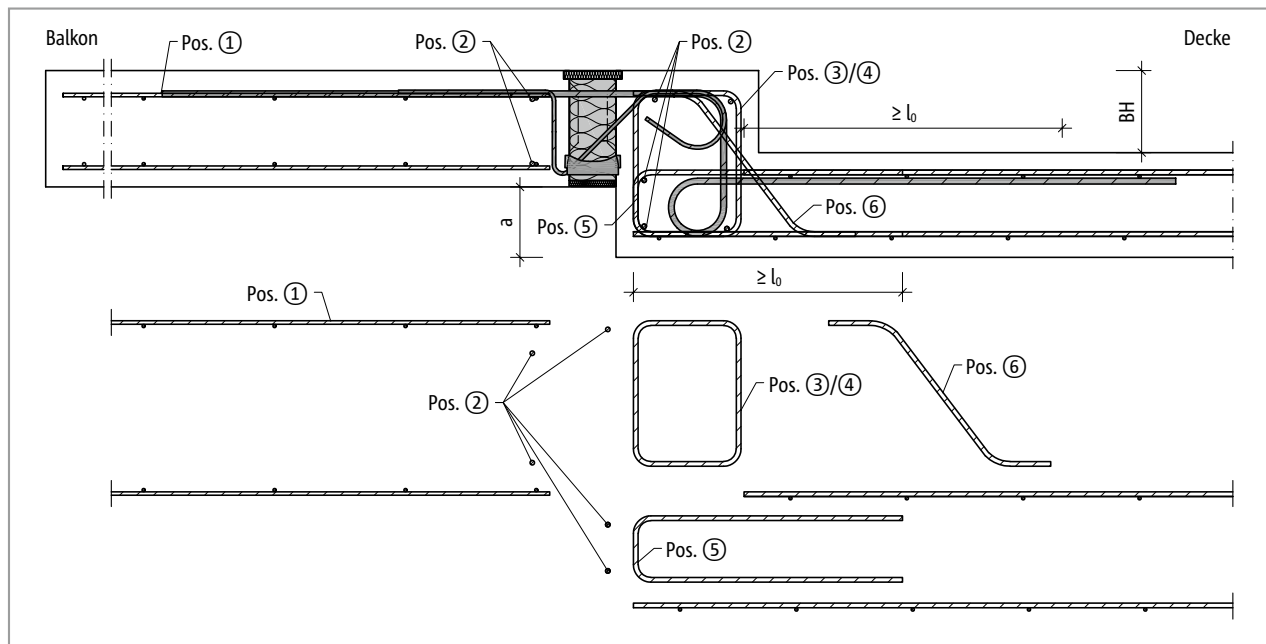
Schöck Isokorb® T Typ K-BH: Bauseitige Bewehrung
